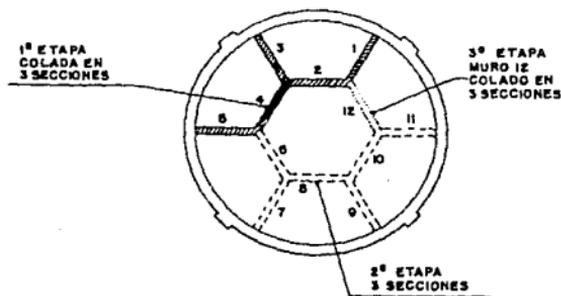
Procedimiento de construcción para muros a N+182.10
